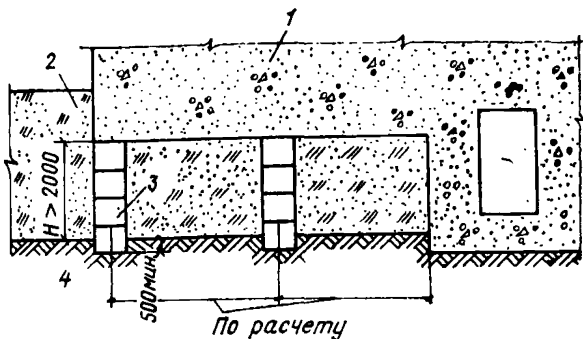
Опираие фундамента оборудования при слабых или насыпных грунтах
